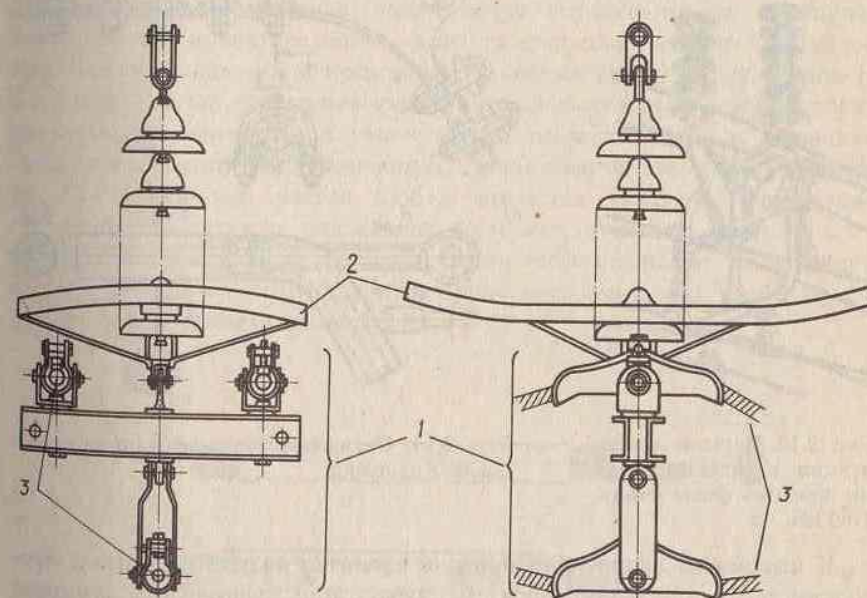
Конструкция крепления к подвесной гирлянде изоляторов трех проводов расщепленной фазы линии 500 кВ
